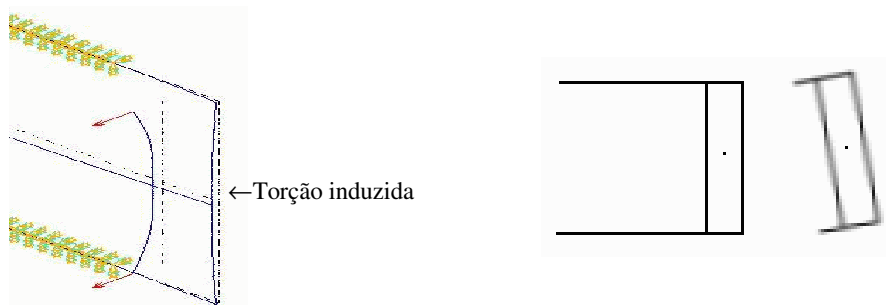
Aplicação de carregamento vertical: deslocamento vertical do elemento central e consequentemente giro induzido nos elementos laterais  $B$
